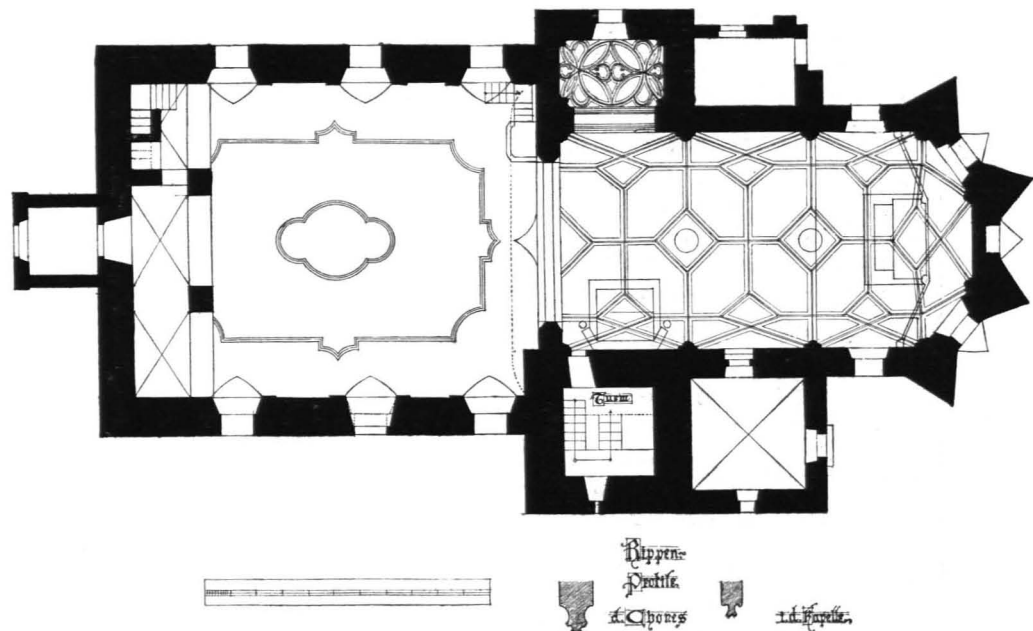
Sallapulka, Wallfahrtskirche Maria im Gebirge, Grundriß 1:300 (S. 240)
